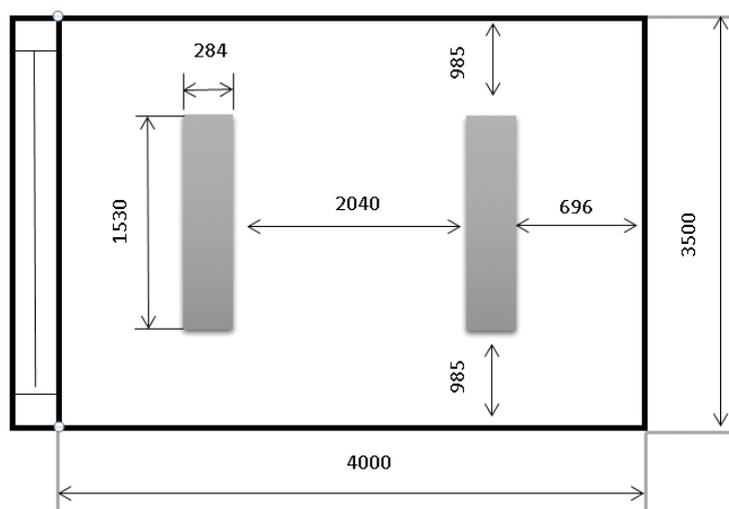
План расположения светильников в рабочем помещении
